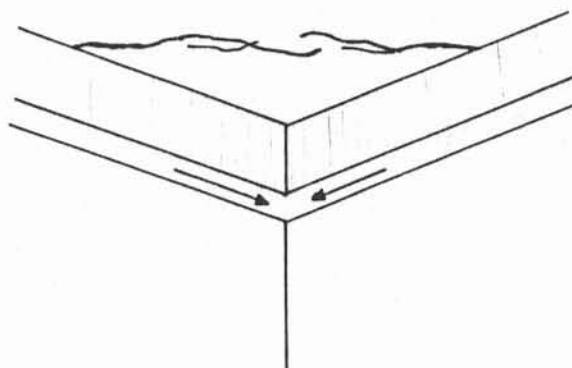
Fissura em laje causada pela expansão térmica das vigas de apoio.
